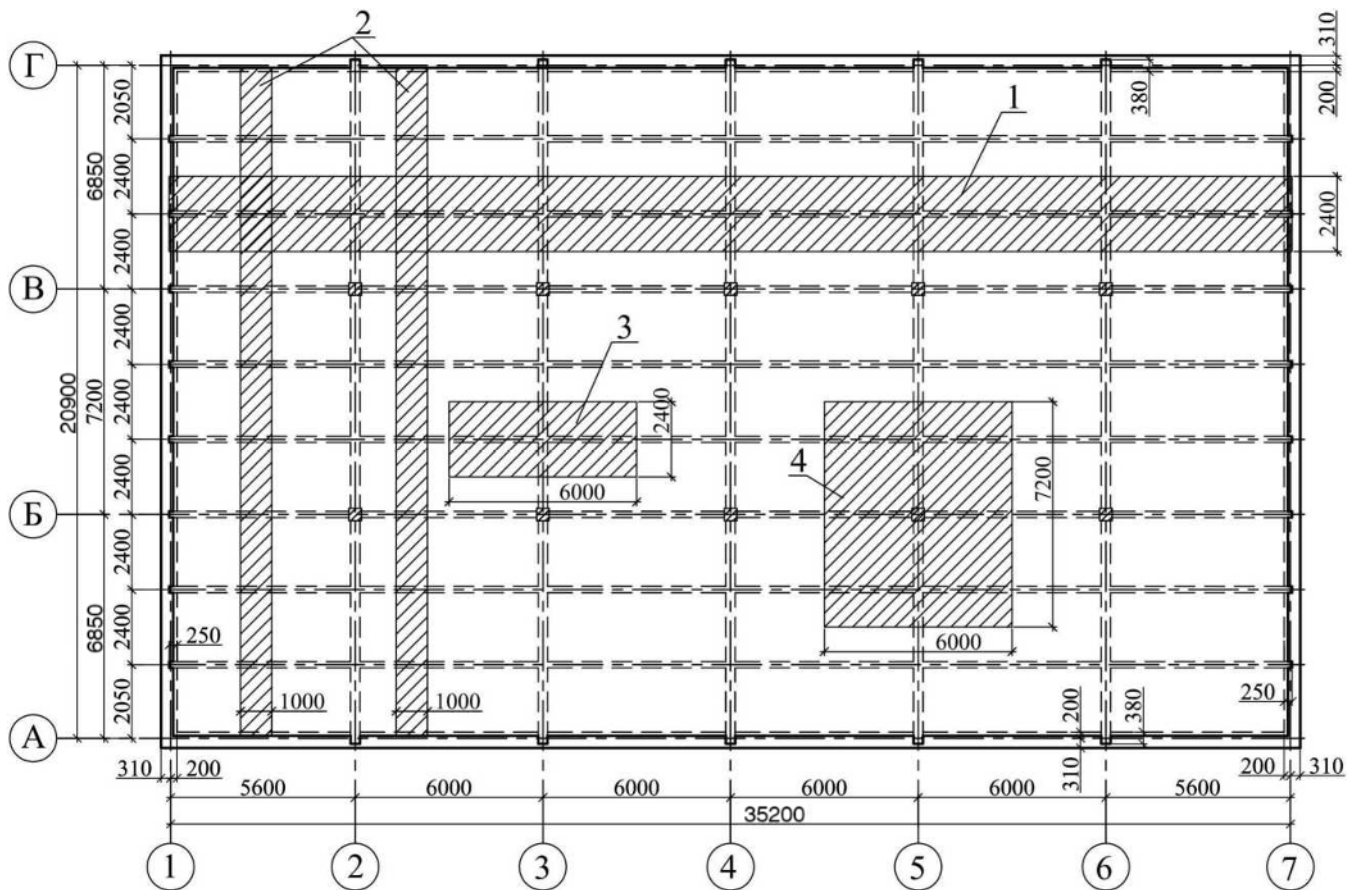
Вантажні площі елементів перекриття: 1 - вантажна площа для розрахунку другорядної балки; 2 - вантажна площа для розрахунку плити; 3 - вантажна площа для розрахунку головної балки; 4 - вантажна площа для розрахунку колони
